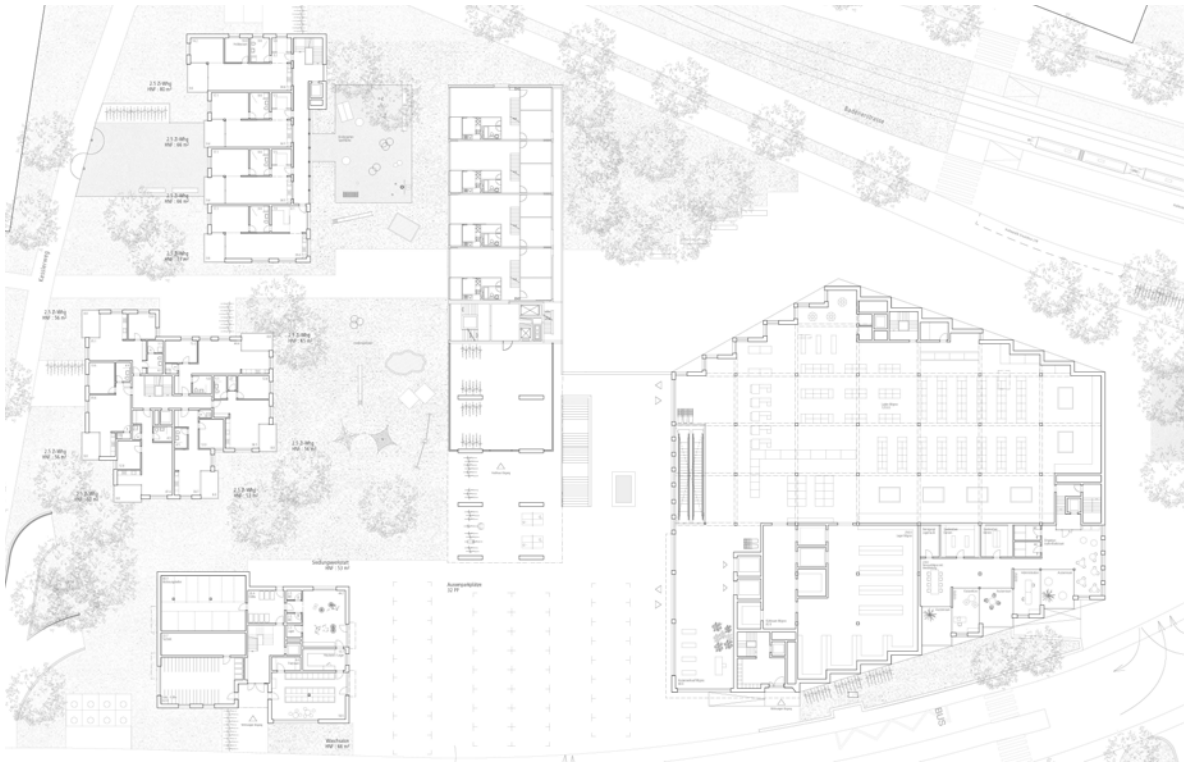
Kessler Quintett: Grundriss Ebene Kesslerstrasse
